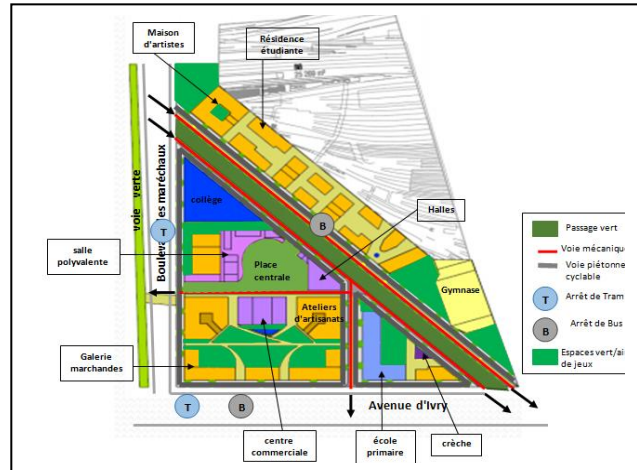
Un plan de masse récapitulatif (source: conception d'un éco-quartier sur le site Masséna Bruneseau.pdf (+ modification par L'auteur))
